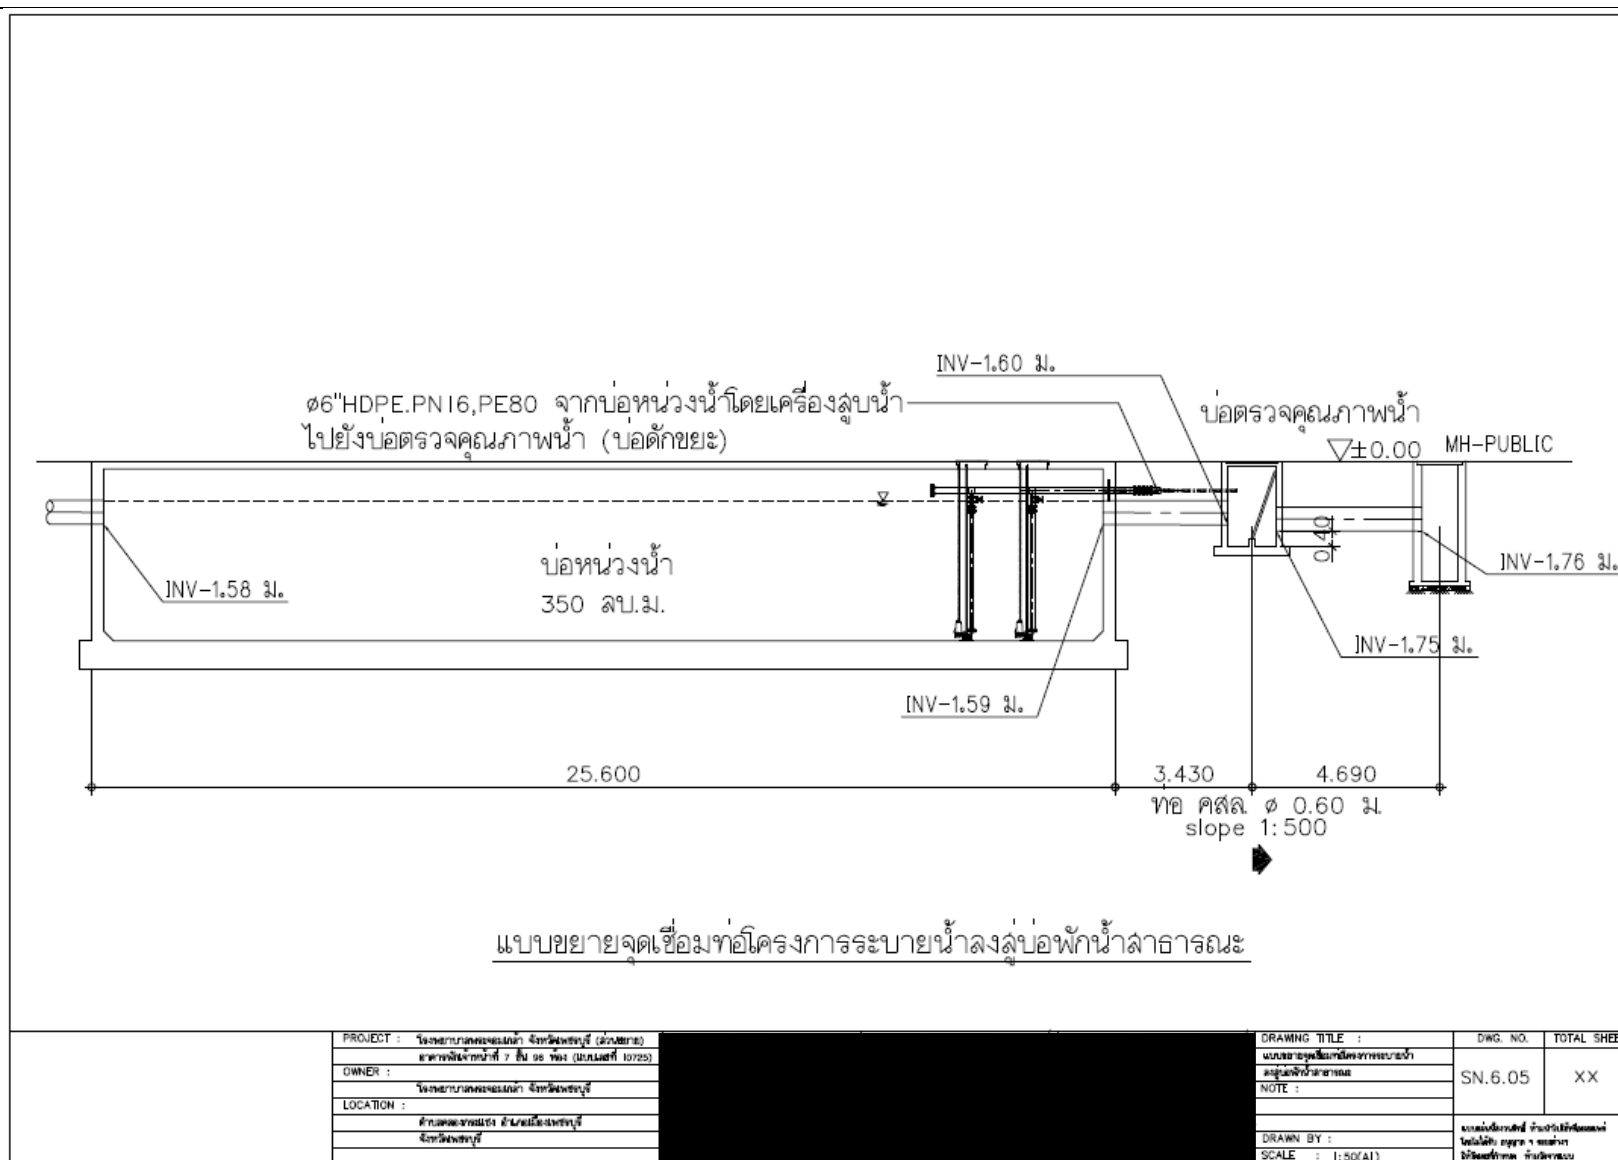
ผังแสดงค่าระดับท่อระบายน้ำฝนภายในโครงการ (ต่อ)
